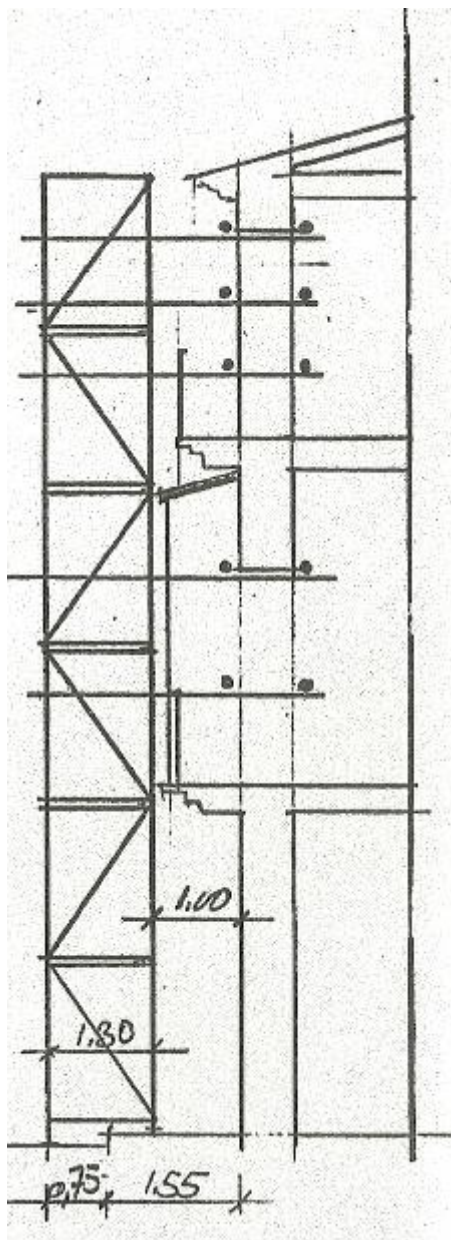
Croquis del sistema de mantenimiento de la fachada. (Fuente: VNB Arquitectos)
